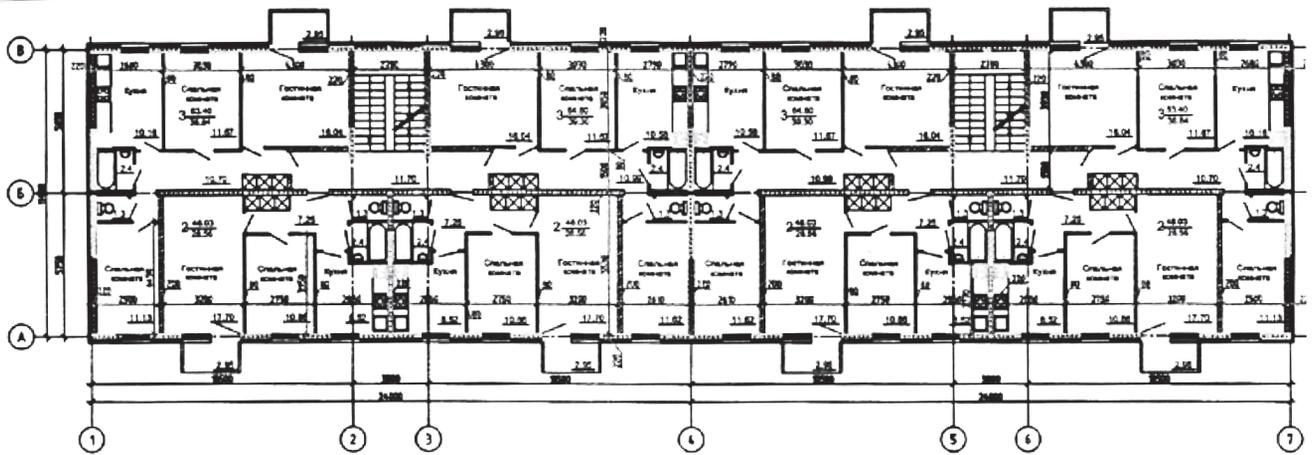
Многоэтажное здание из вертикальных панелей со встроенным каркасом
